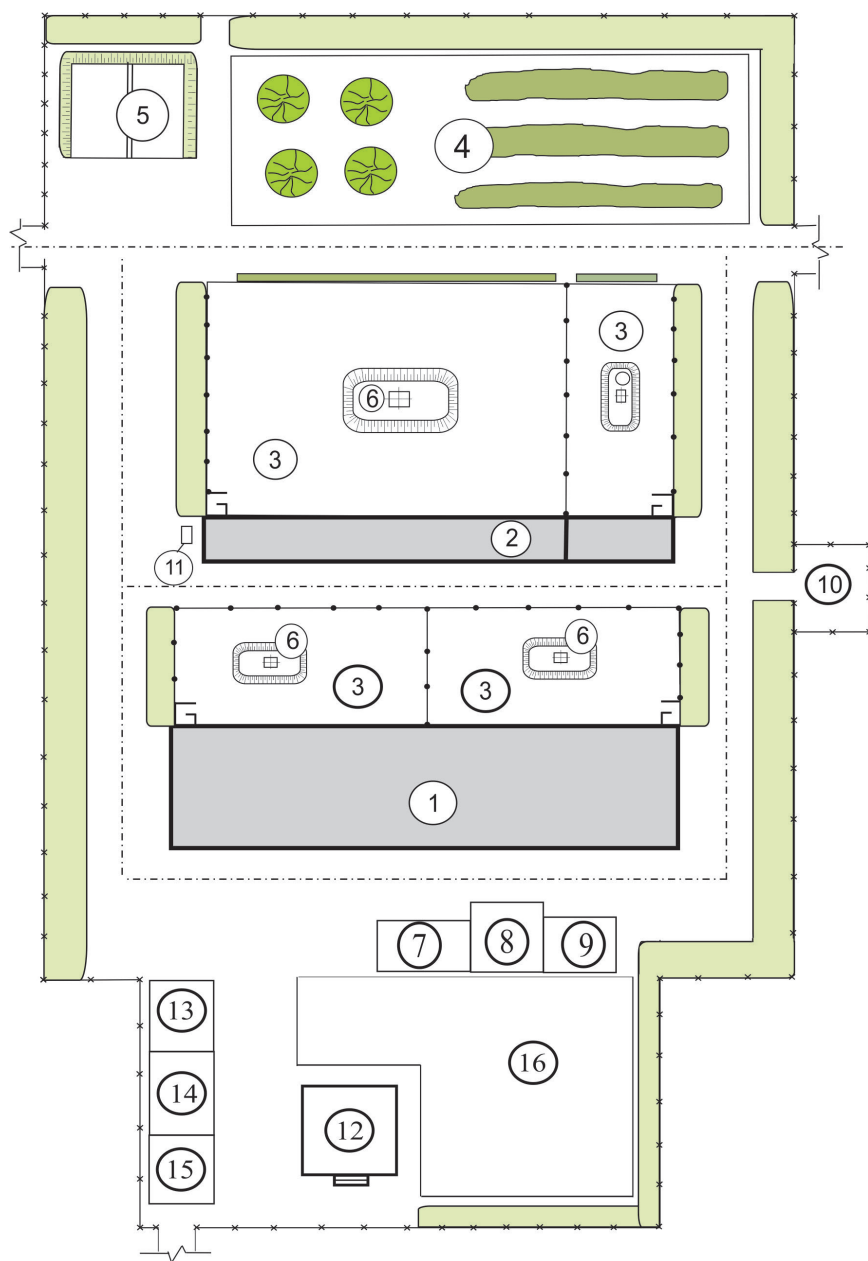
Схема генерального плана семейной фермы на 26 коров мясного направления:
